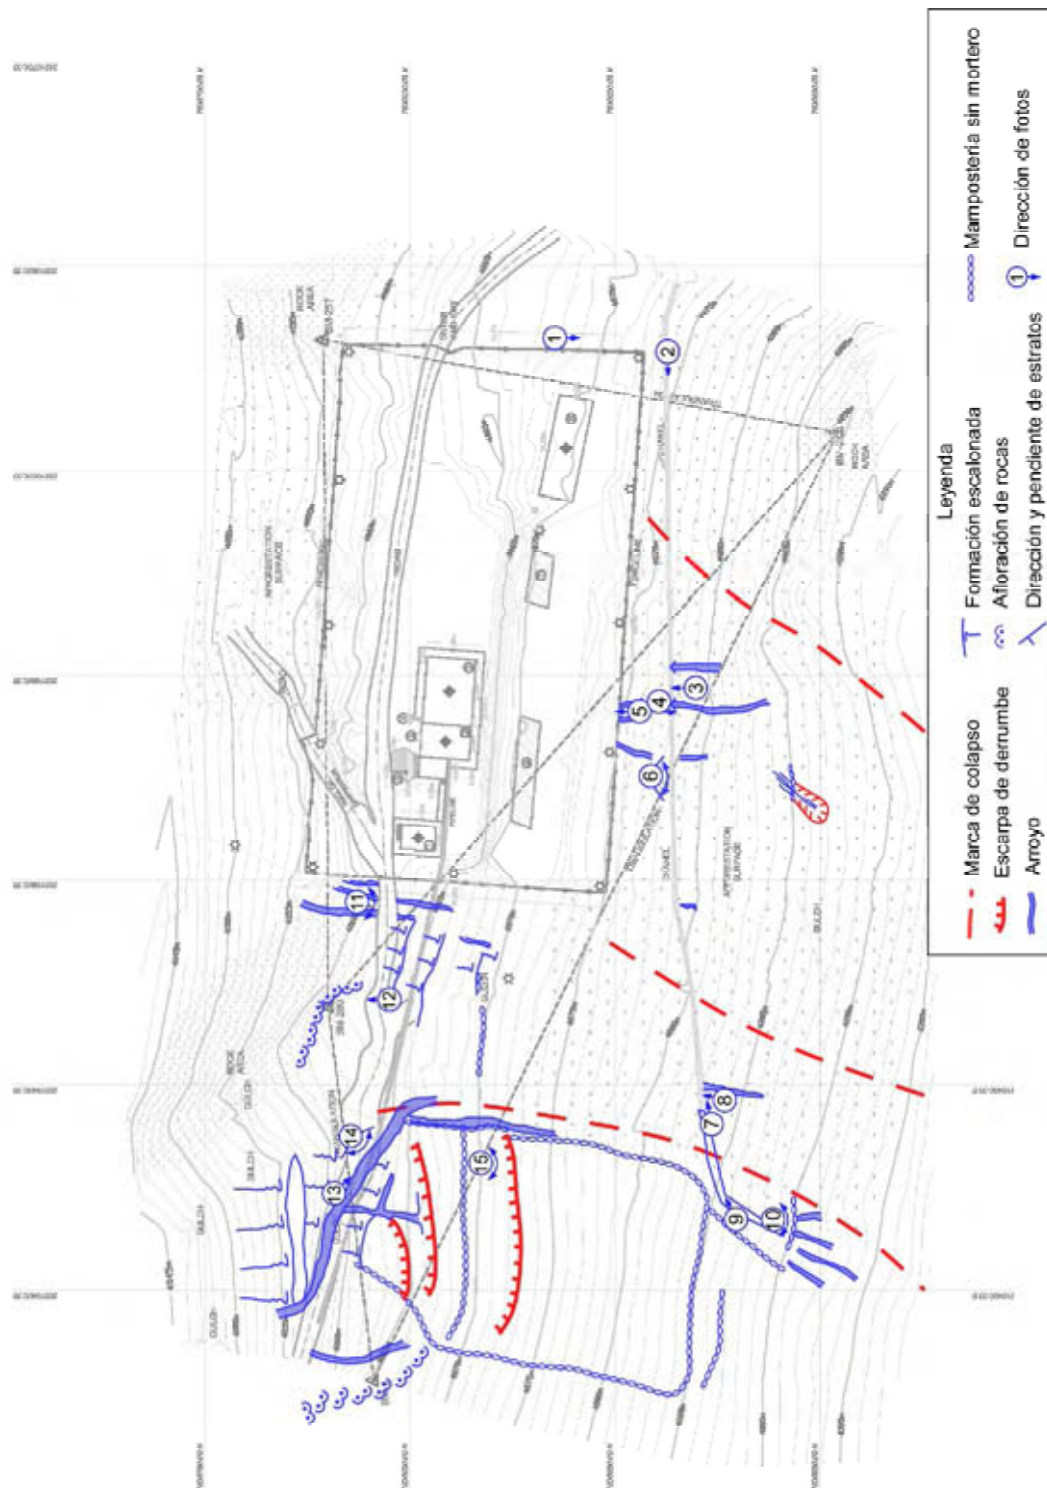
Condiciones del terreno previsto para la construcción de la Planta de Tratamiento de Agua y el terreno adecuado
